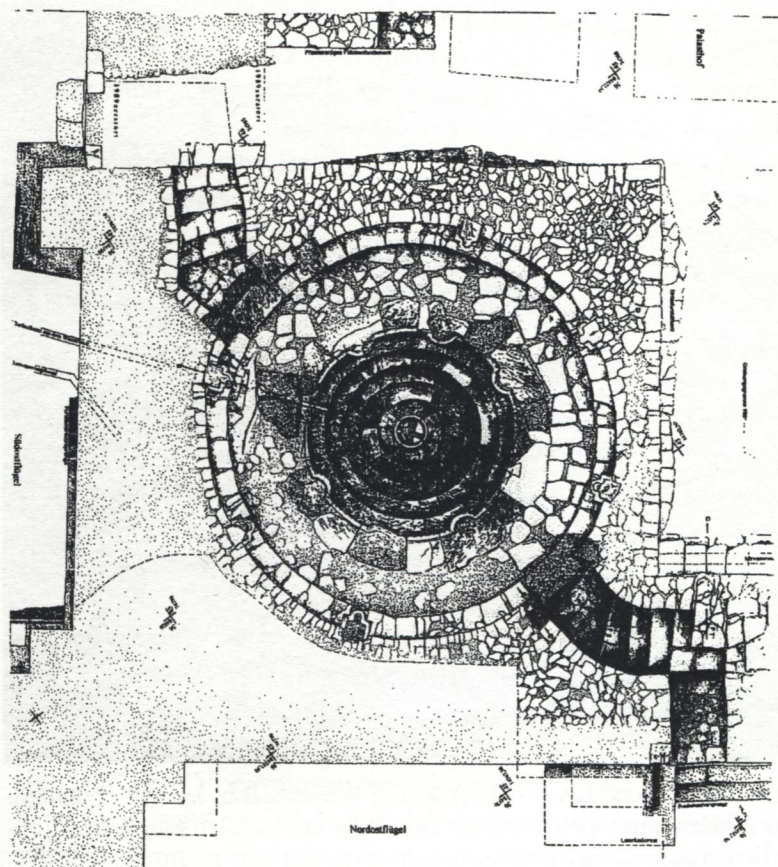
„Wüstes steynhus“ bei Oschatz, Grundriss des Badehauses.
